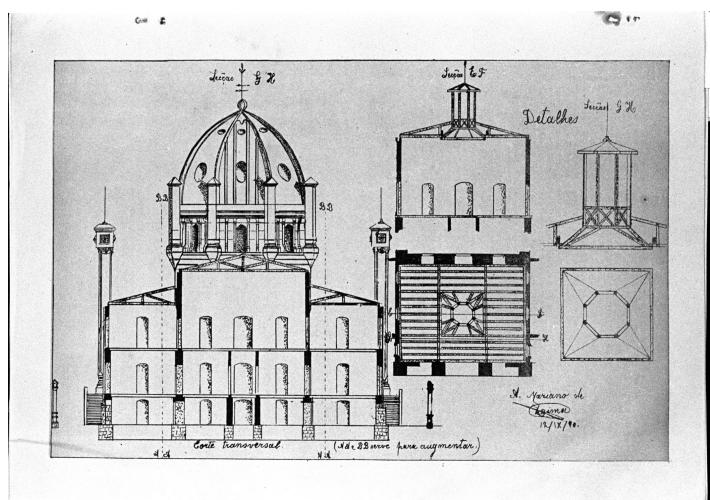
Projeto para a Escola de Artes: corte transversal e detalhes do lanternin.
